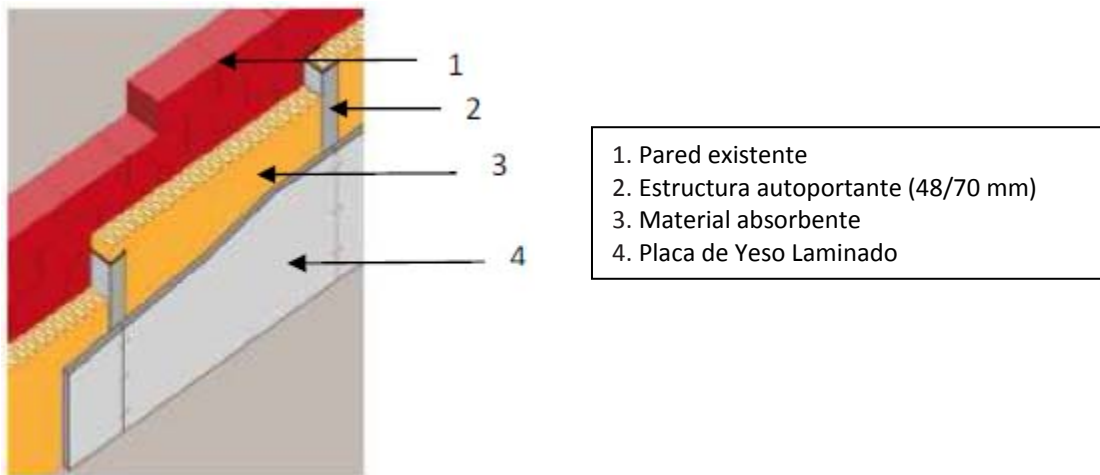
Detalle de trasdosado autoportante de placa de yeso laminado
